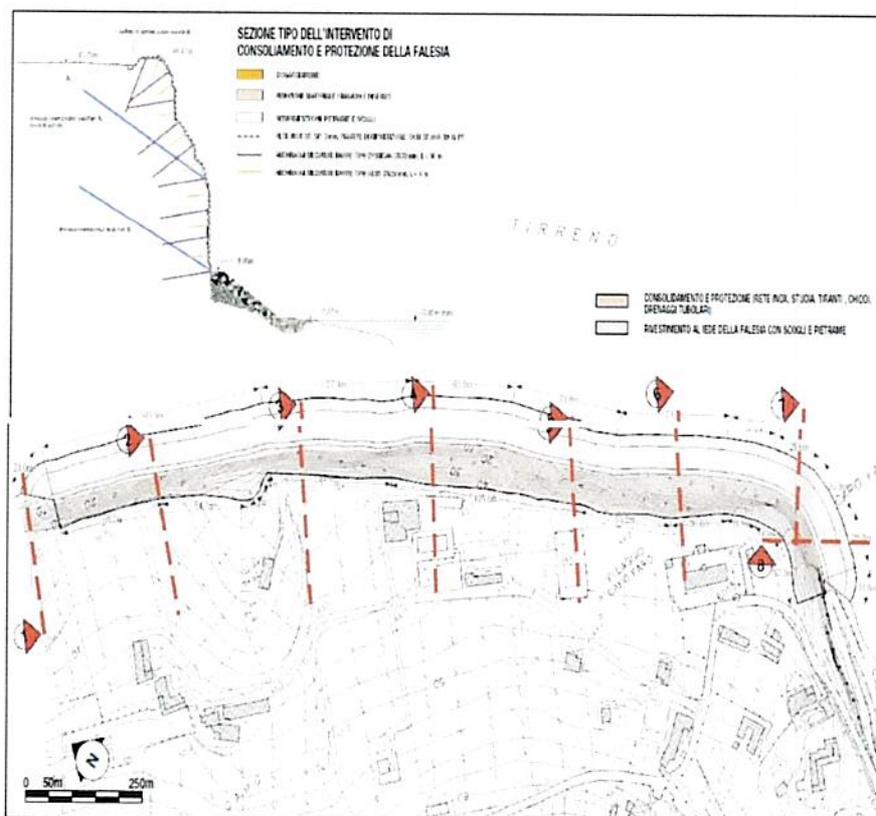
Planimetria sinottica degli interventi da realizzare (elab. OP.01)
